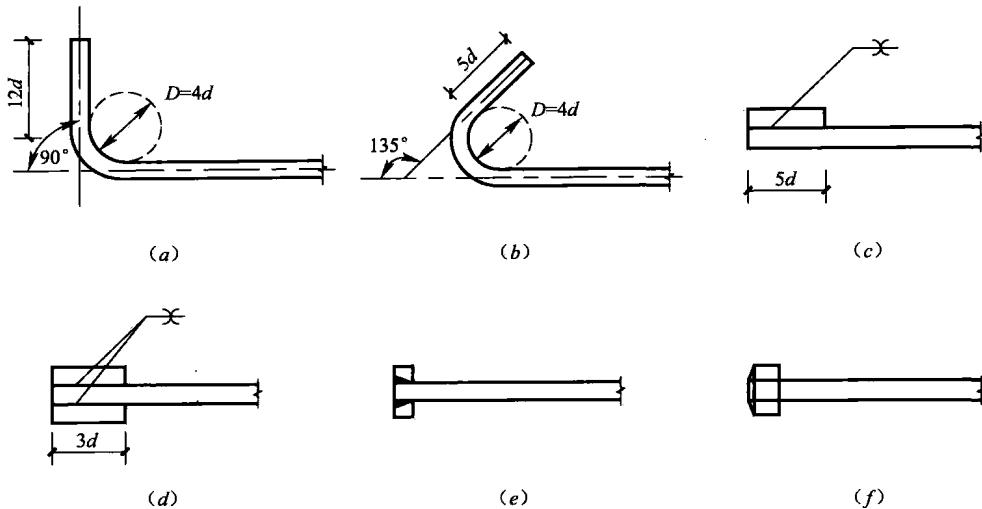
《混凝土结构设计规范》中图 8.3.3 钢筋机械锚固的形式及构造要求
